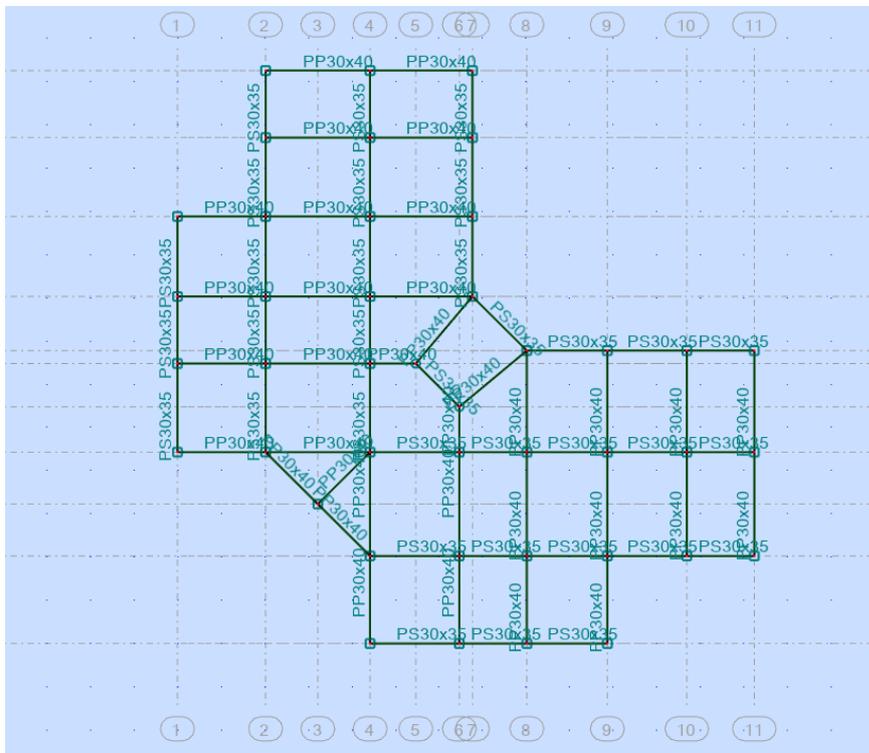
Vue en 2D des poutres et des poteaux.
